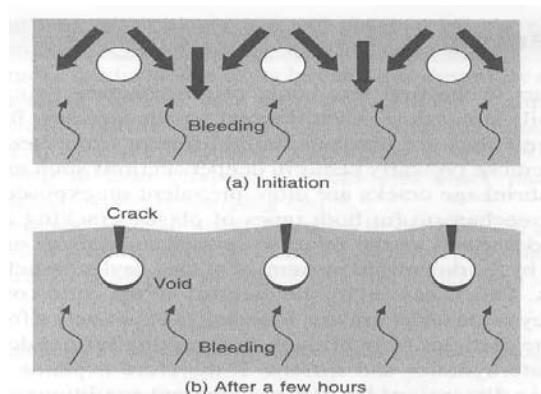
Formación de fisuras por asentamiento.
